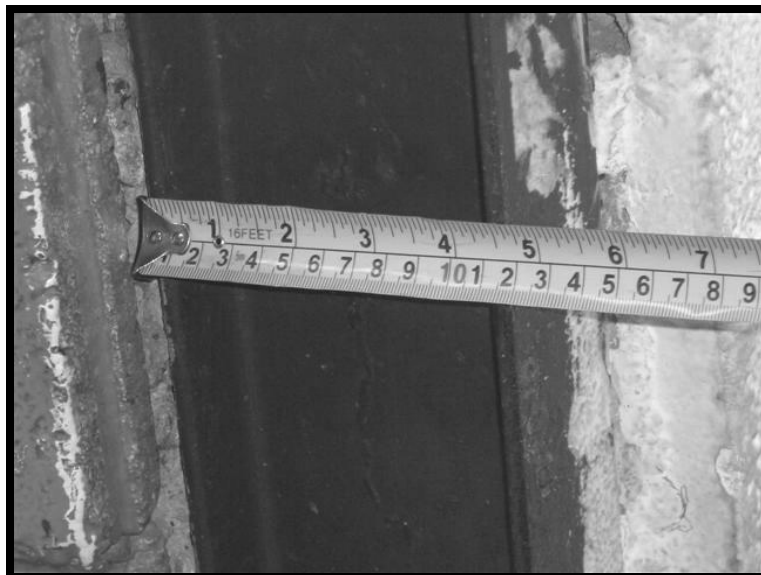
Edificación 2. Empernado de los elementos metálicos. Anclaje de las barras tensores de arriostramiento del techo en el tope de una columna.
